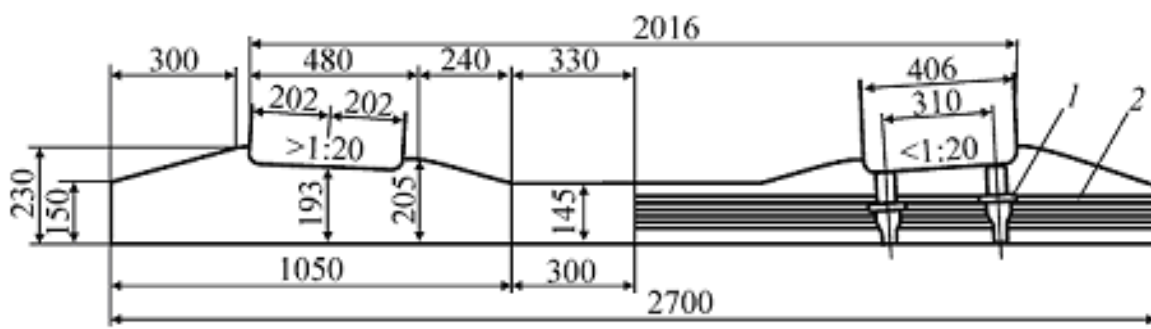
Железобетонная шпала Ш-1-1: 1 – закладная шайба; 2 - арматура
